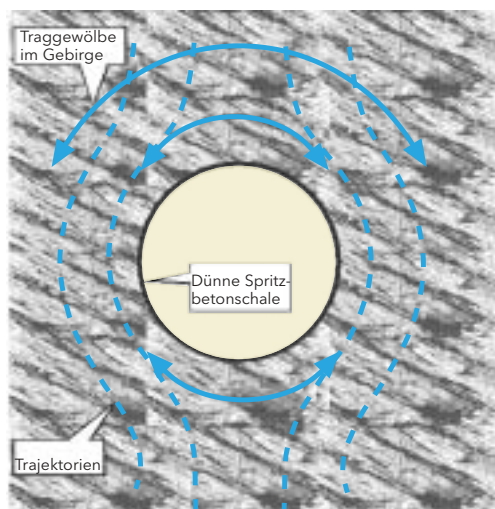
Tragsystem des Tunnelbaus nach der Spritzbetonbauweise
